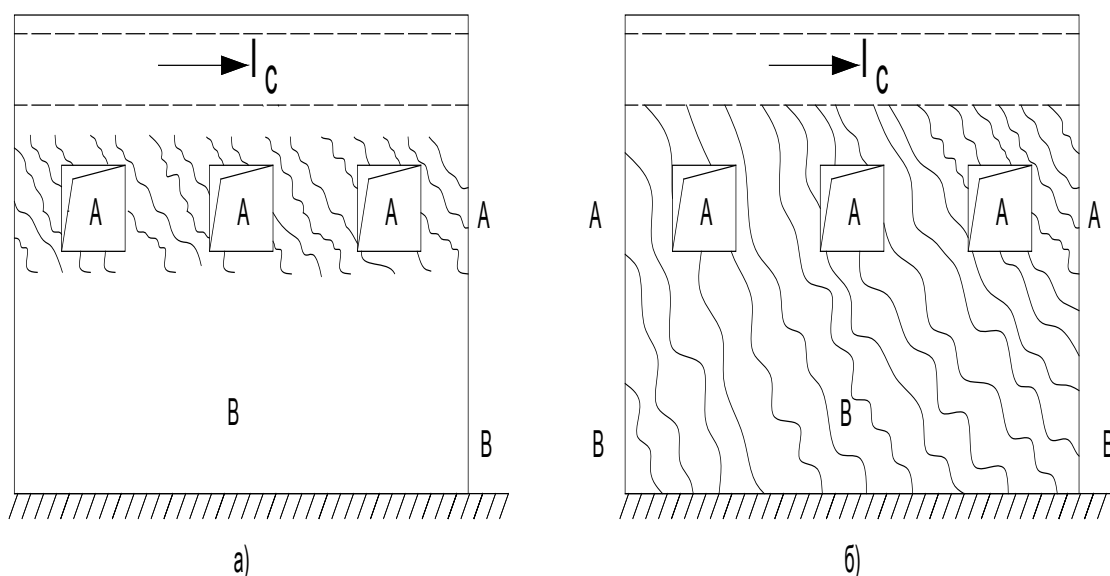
Расчетная схема фрагмента здания с проемами:
